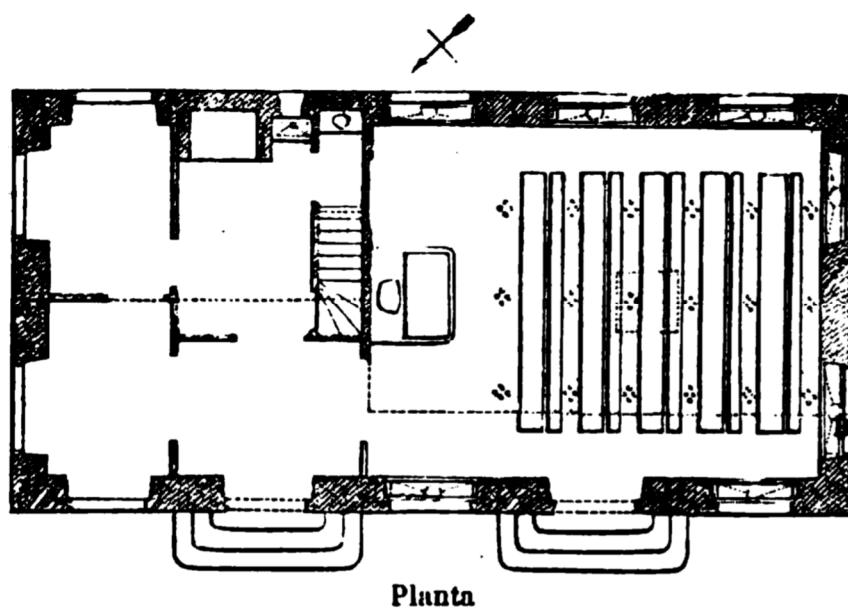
Planta da Casa para Escola Rural – (Ghira, 1864)
